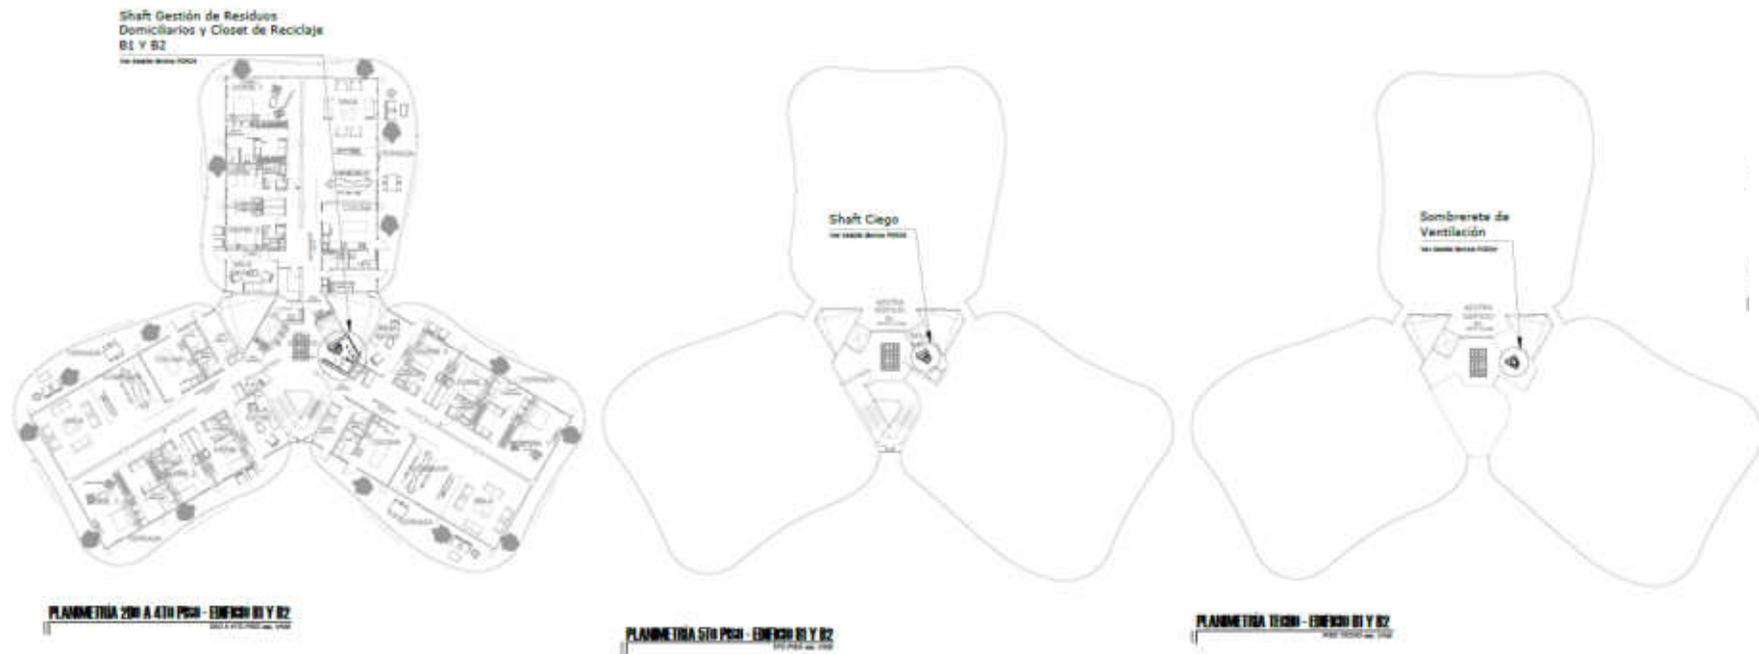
PSGR – Planimetría de 2do a Techo Piso – Edificio B1 y B2
